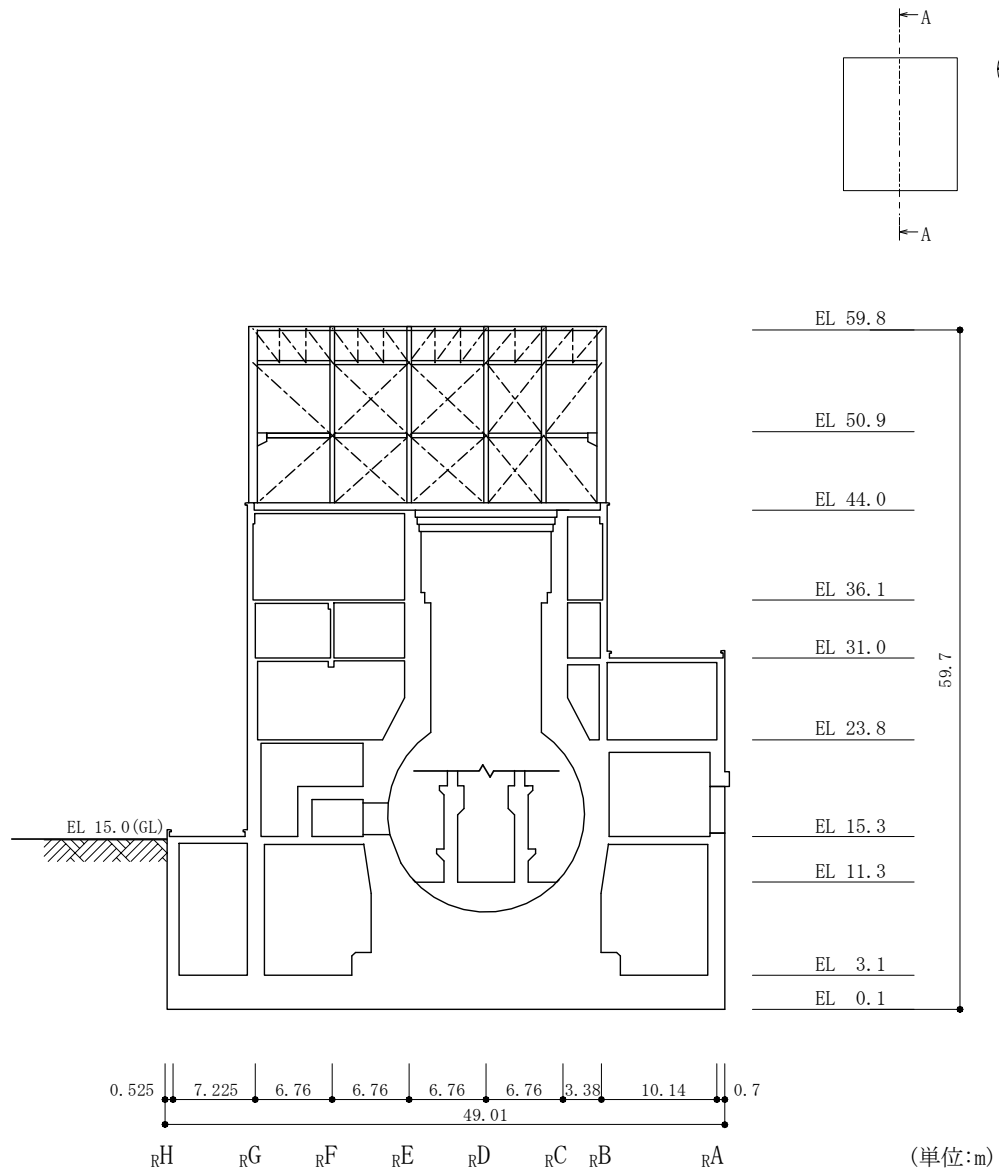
(1) 1号機原子炉建物の概略断面図 (A-A断面, NS方向)
